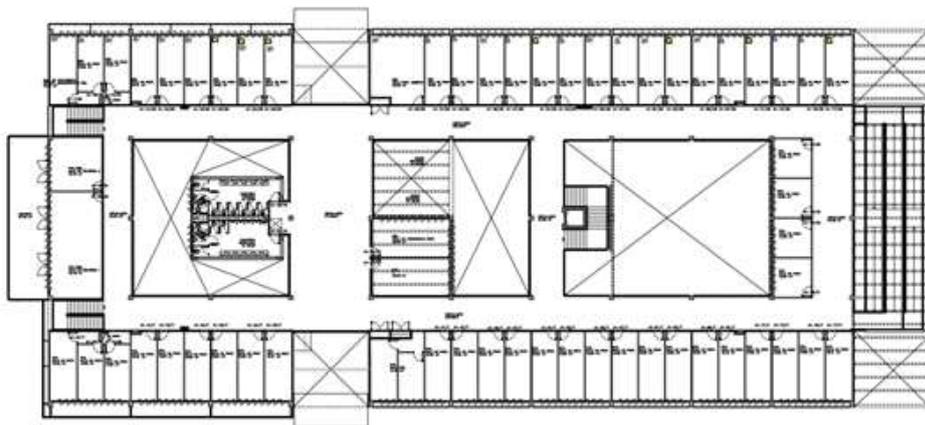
Planta da área térrea do prédio do IPOL/IREL
